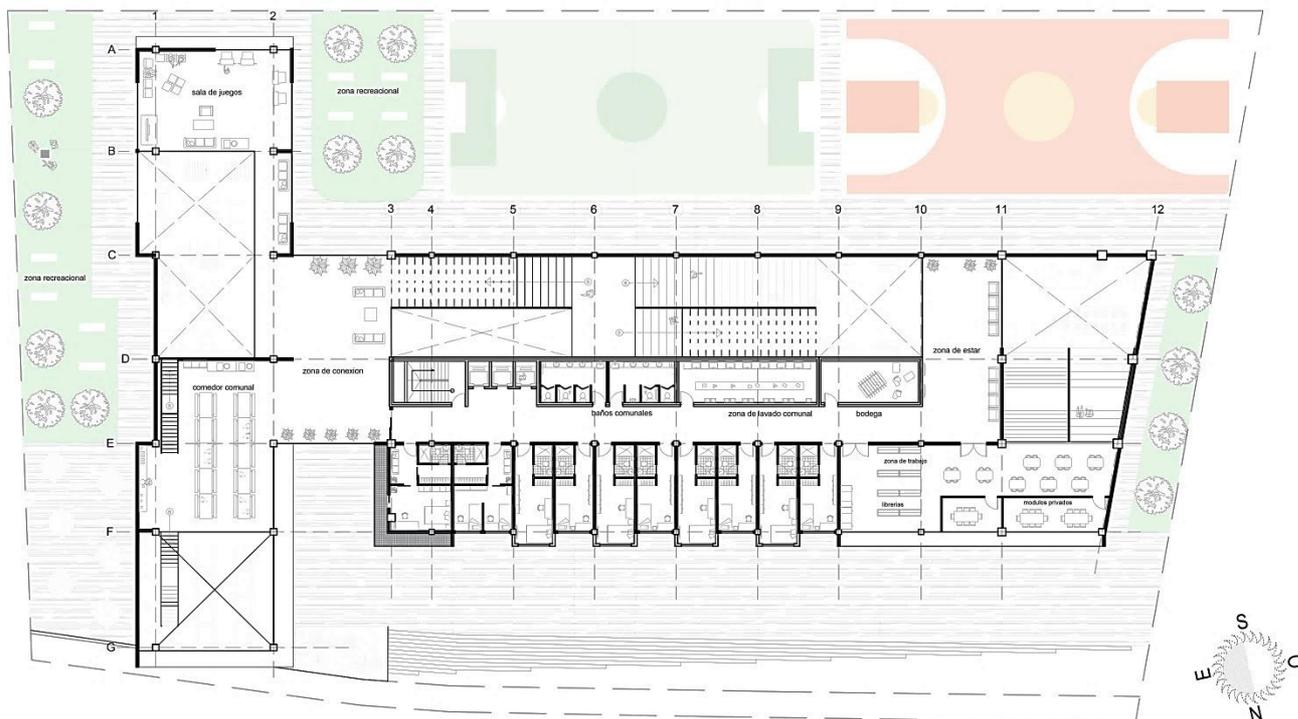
Planta: piso 3 Cevallos. (2018). Creación propia
